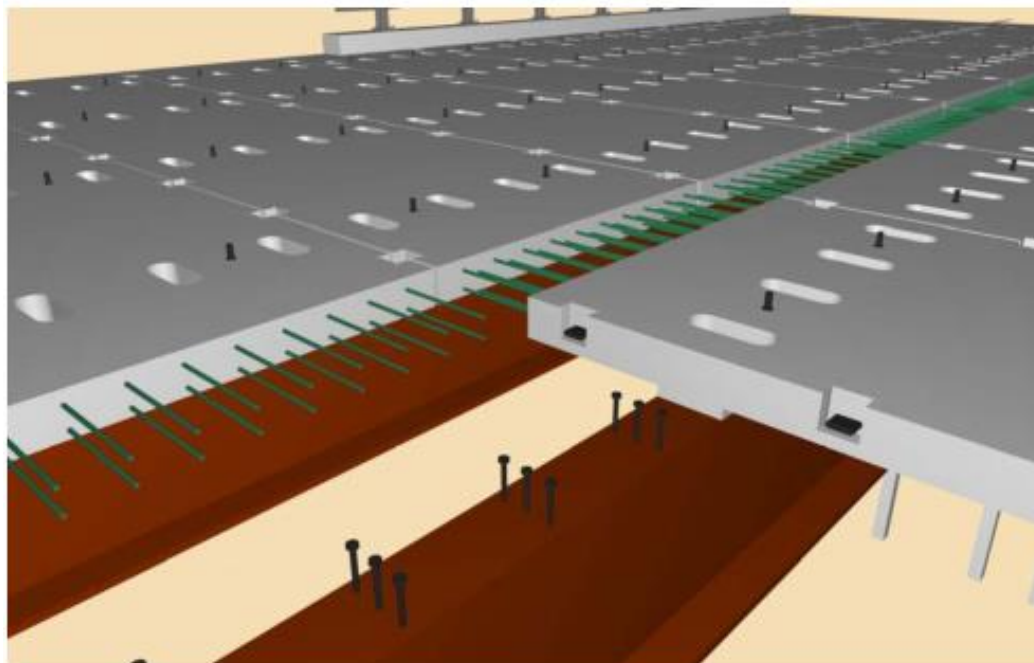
Connexion dalle-poutre localisée (Culmo, 2009)
